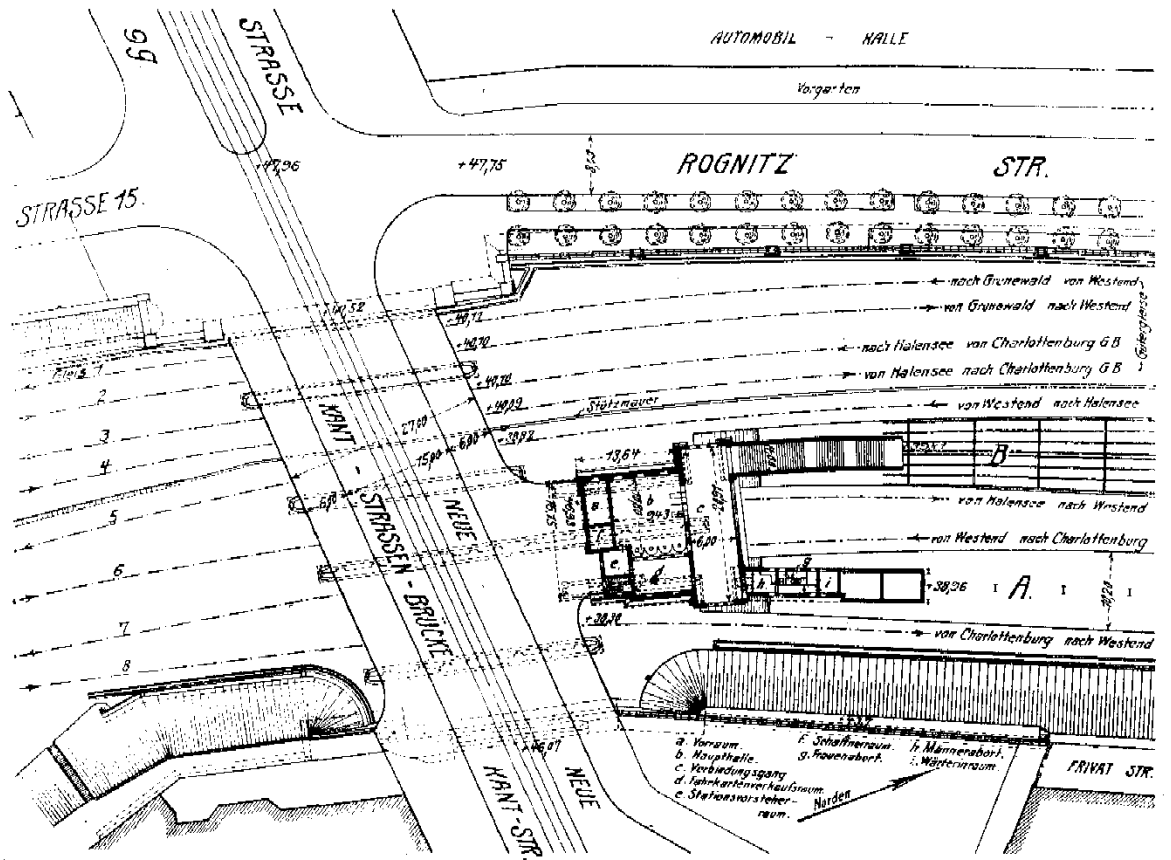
Lageplan des Empfangsgebäudes an der Brücke im Zuge der Neuen Kantstraße. M. 1: 1000.
